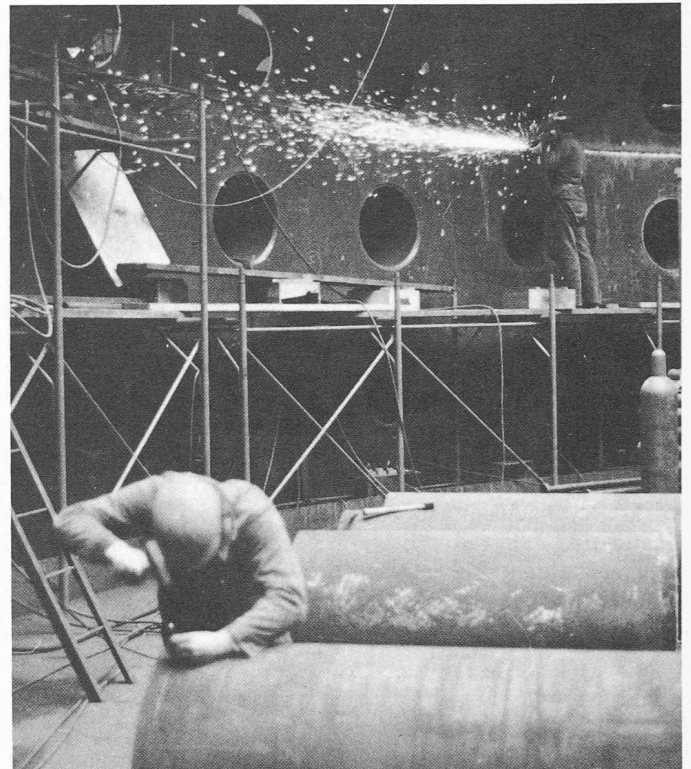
Montagearbeiten am Drywell. Vorbereiten eines VO-Rohres zum Ablängen vor dem Einbau
